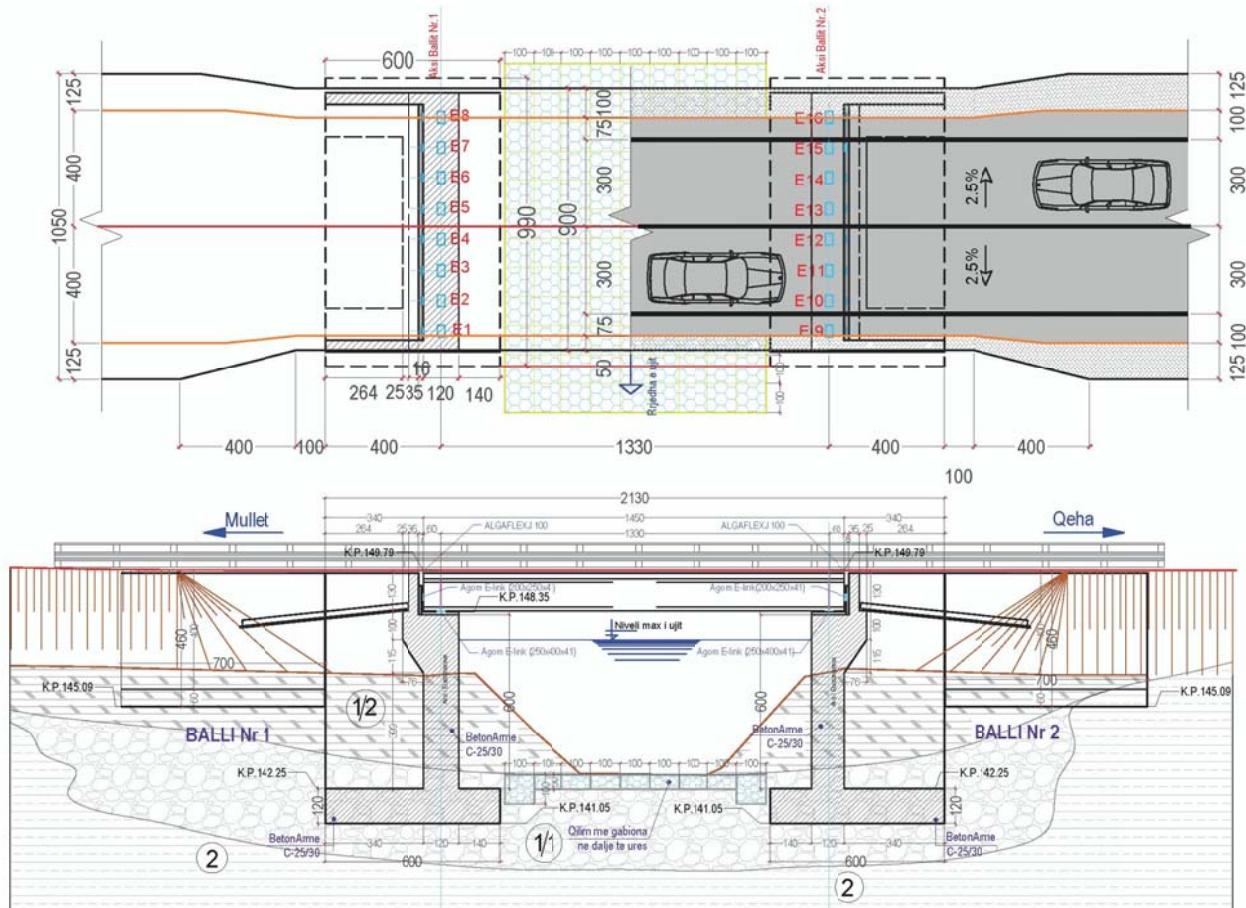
Planimetria dhe Prerja gjatësore e Urës
